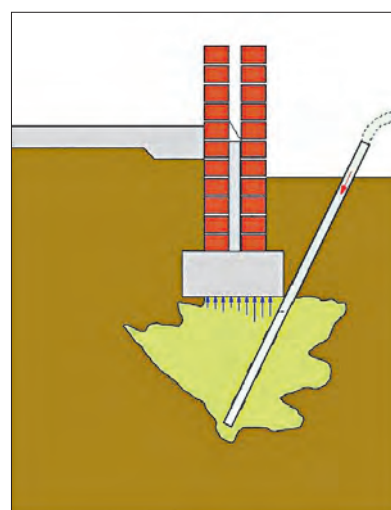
ASIMETRÍA DE DISTRIBUCIÓN DE LA INYECCIÓN Y DE LAS PRESIONES BAJO ZAPATA.
